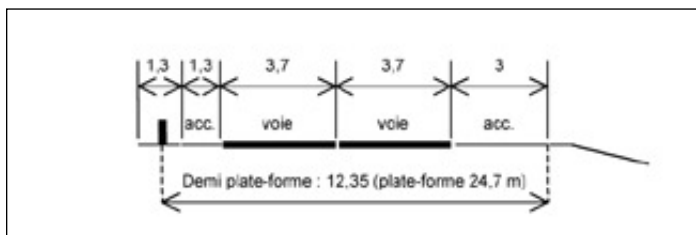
Route nationale à chaussées séparées par un dispositif de retenue central: profil en travers
